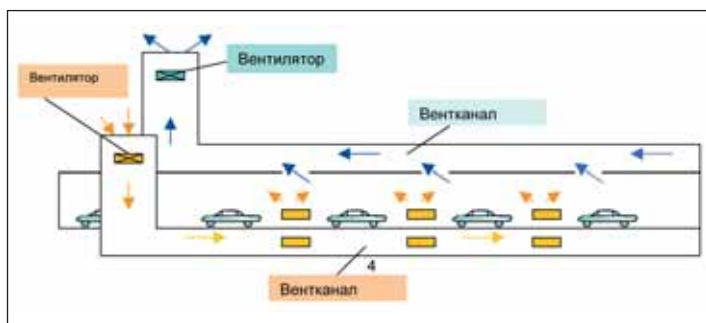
Схема воздухораспределения при поперечной схеме вентиляции
